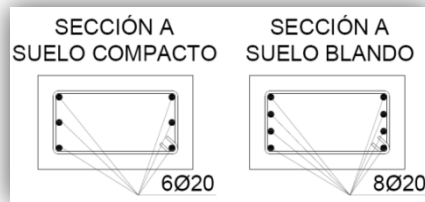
a) Detalle armadura longitudinal Columna Rectangular, sección A
